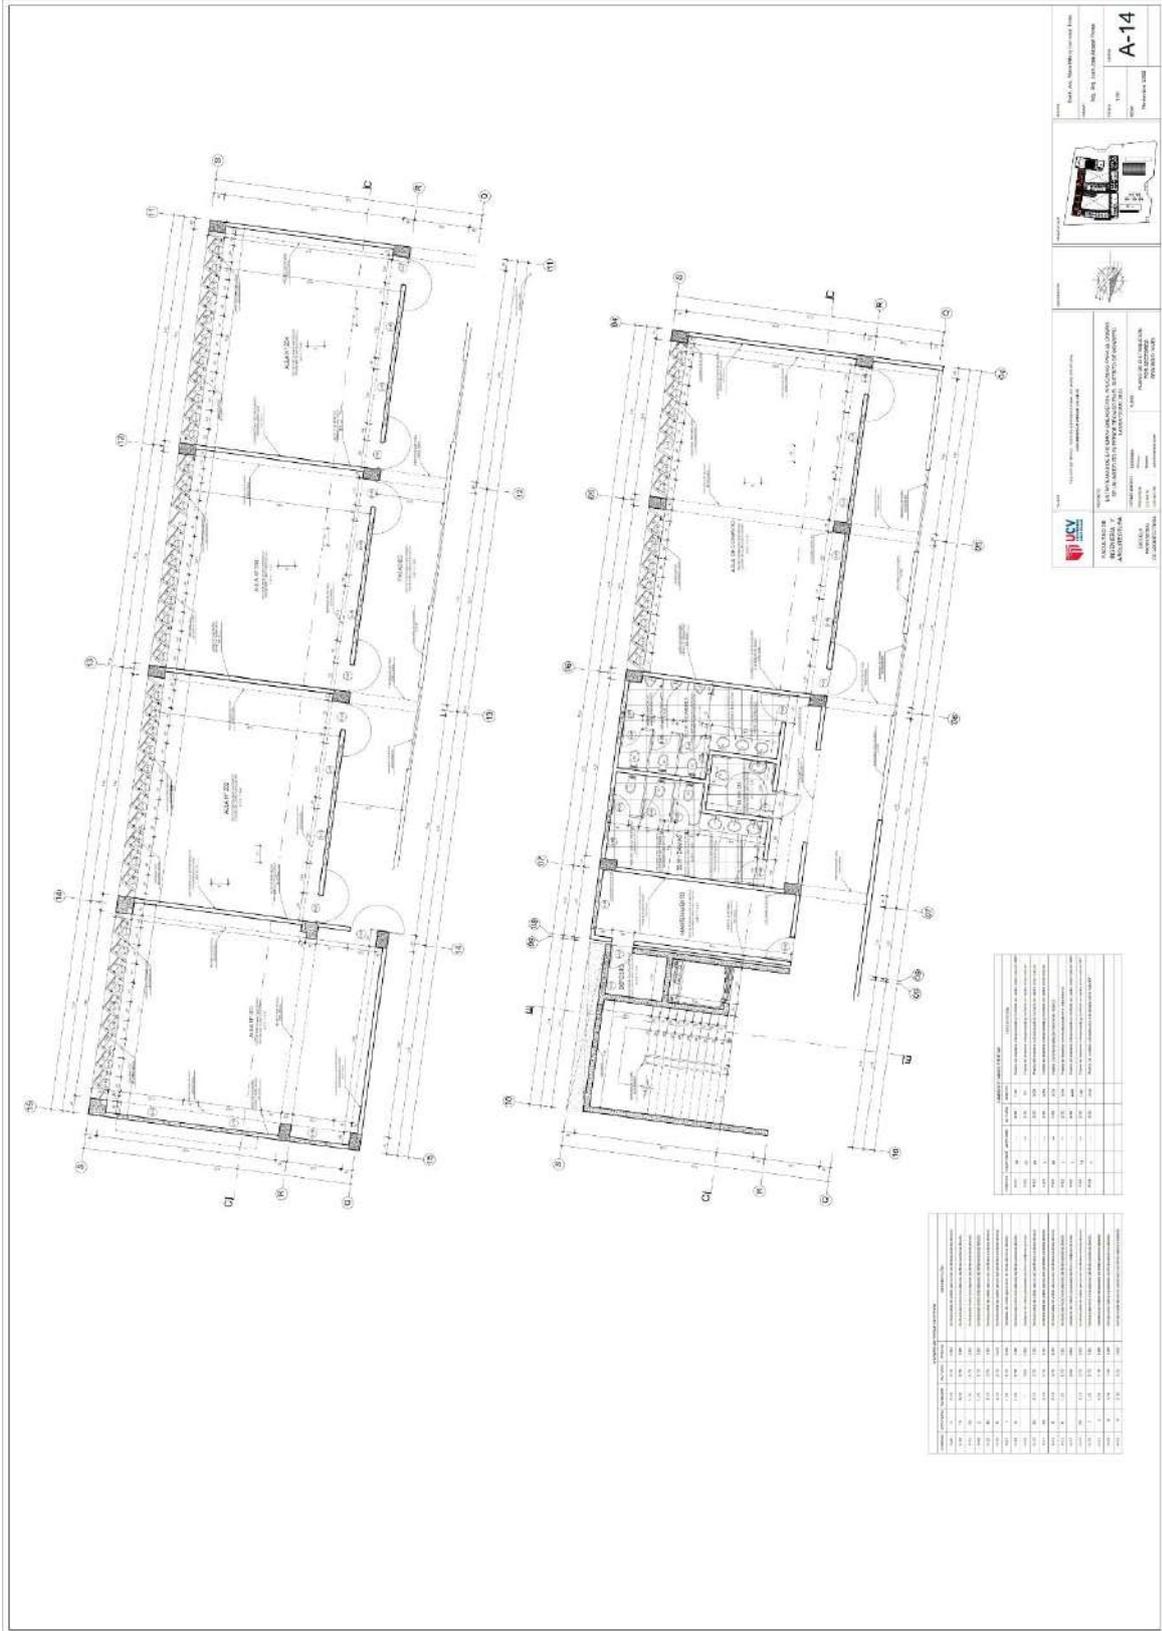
Plano de Sector 2– SEGUNDO NIVEL
